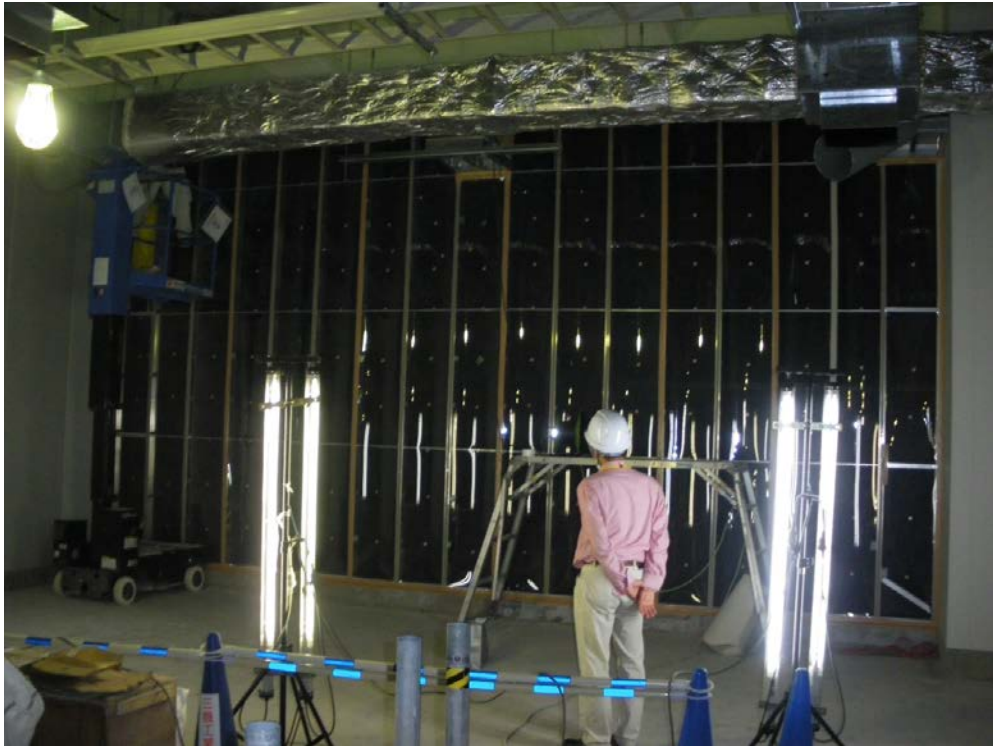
テルモ富士宮工場西 4 号棟実施工試験体
